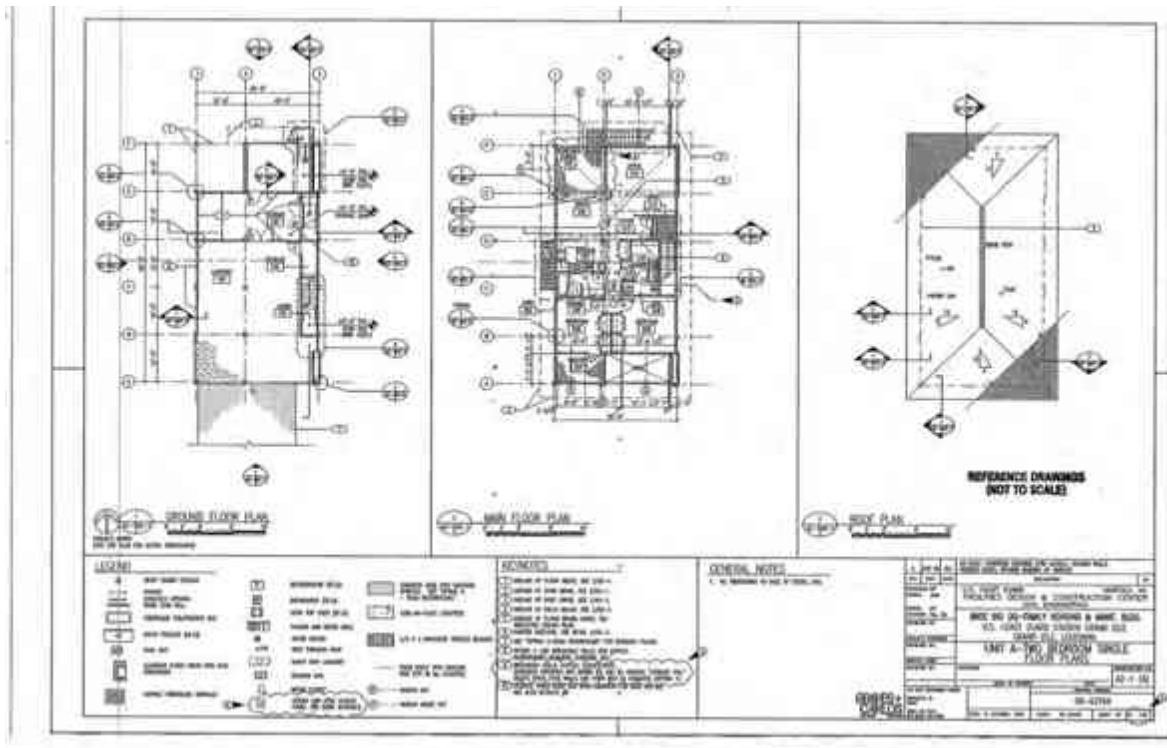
Muestra de planos de apoyo para licitación. Autor: JAPG.
